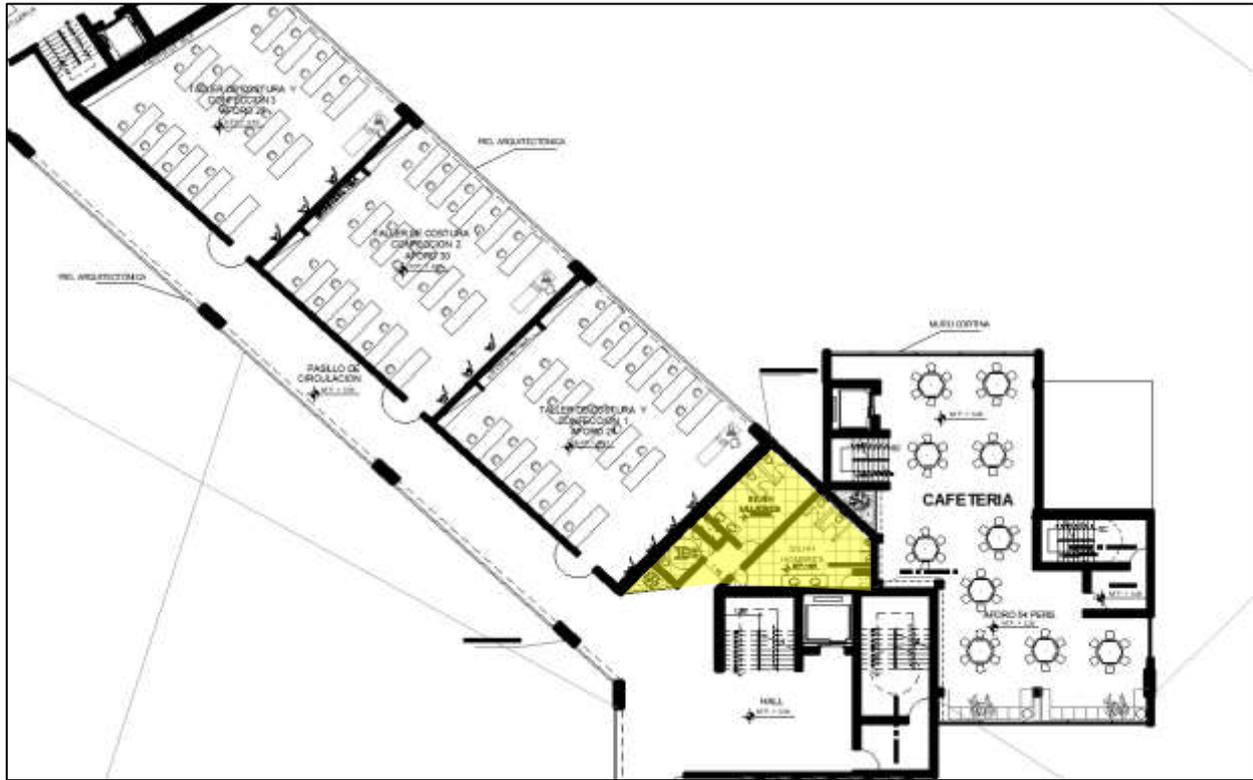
Planta segundo nivel del proyecto-zona educativa. FUENTE: Elaboración propia.
